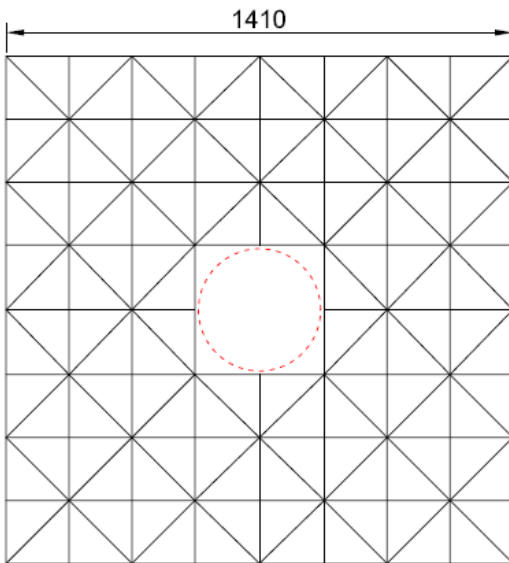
Plantas Piso 1 y 2 (parrillas metálicas)
